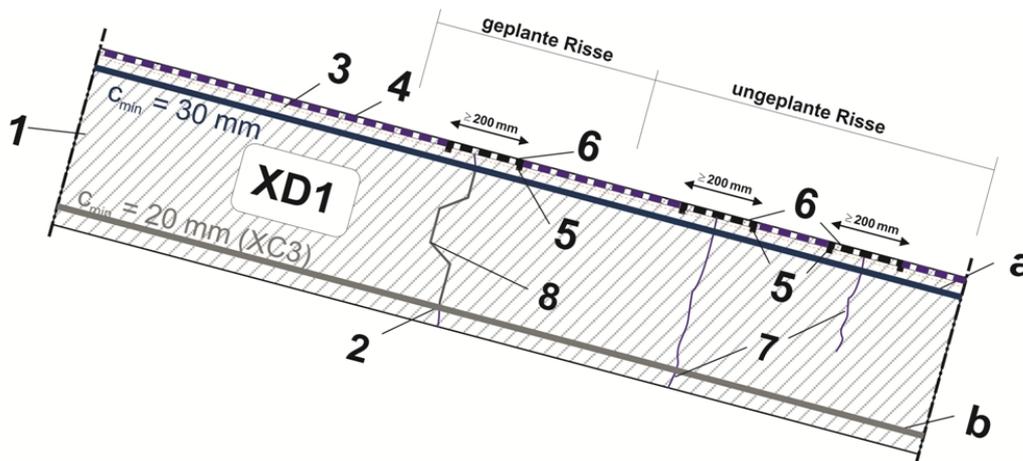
WU-Bodenplatten in Tiefgaragen Ausführungsvariante B – mit flächigem Oberflächenschutzsystem Variante B1 - Beton vollflächig starr beschichtet: OS 8 mit begleitender Rissbehandlung
